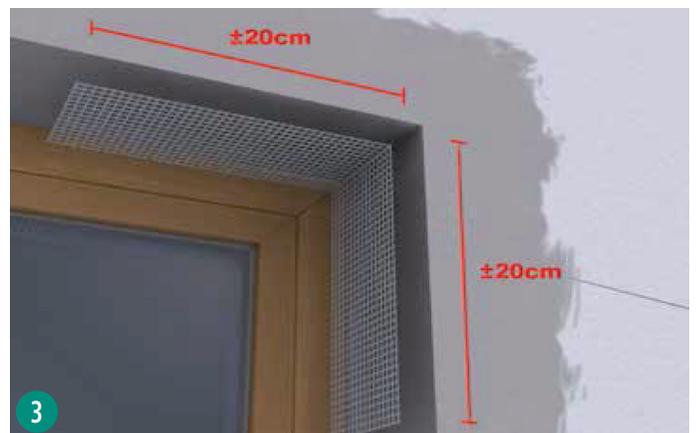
Embeber vendas de malla de fibra de vidrio tipo Malla Refuerzo Esquina 65x33 o Malla Pulmor 160 en todas las esquinas de los huecos con el mortero Pulmor RVTerm. Las vendas previenen la formación de fisuras en los ángulos, que es donde se concentran los mayores esfuerzos.
